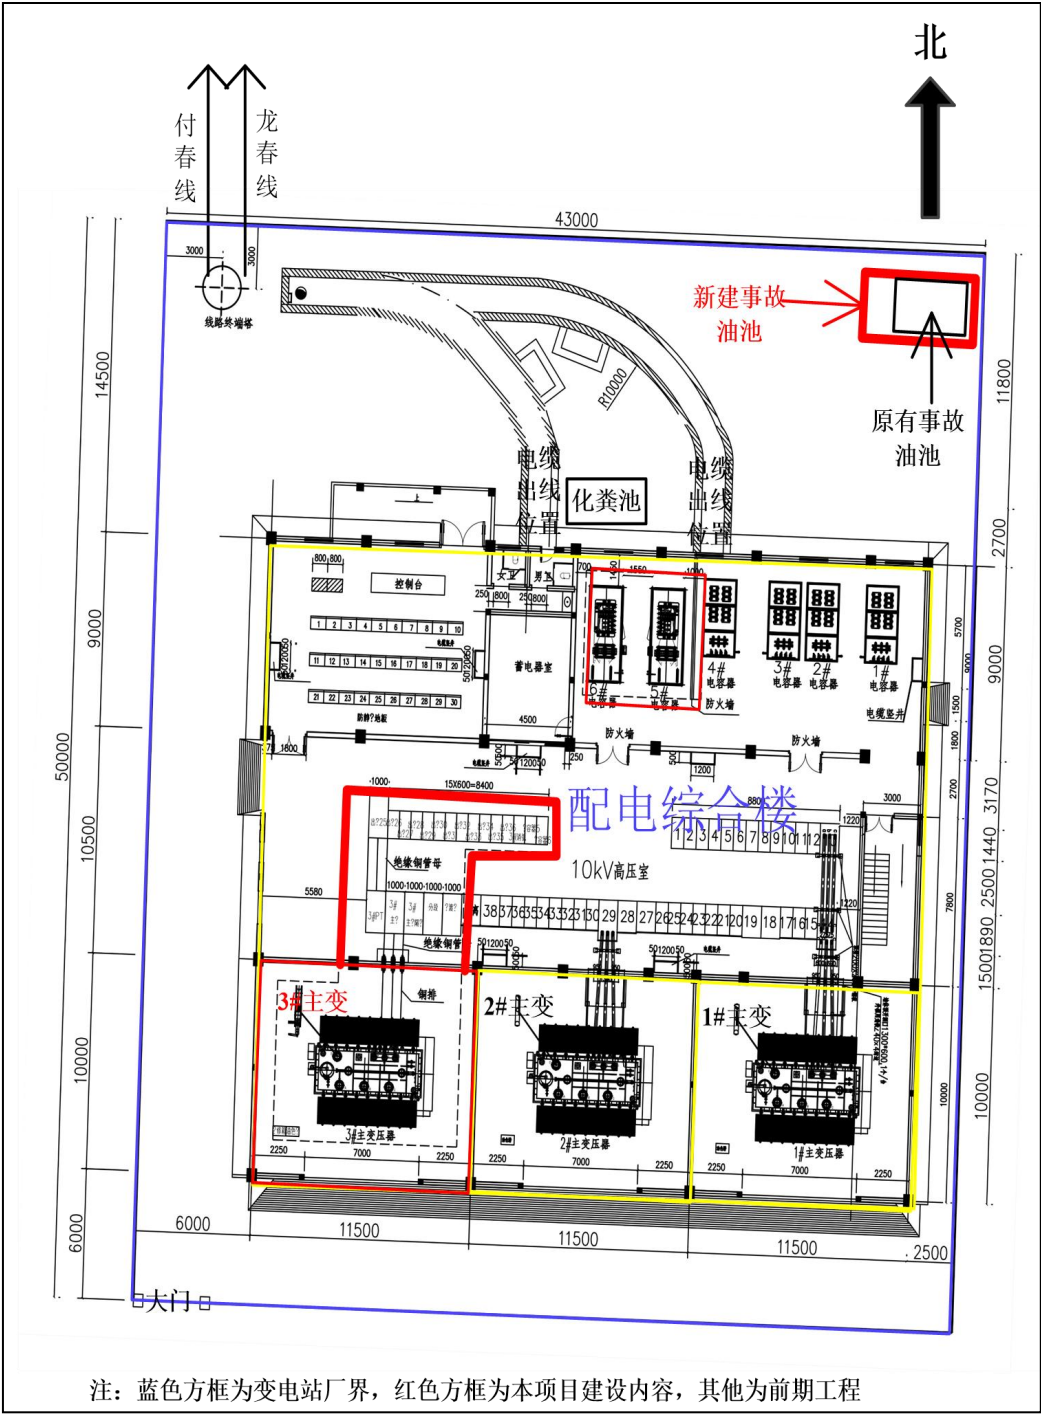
许昌市区春秋 110 千伏变电站平面布置示意图
